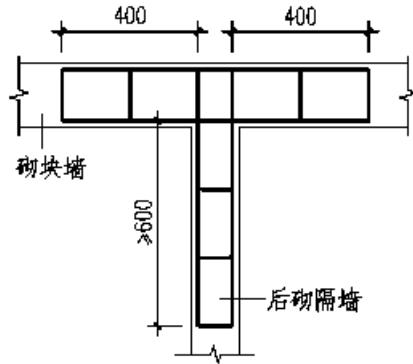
砌块墙与后砌隔墙交接处钢筋网片
